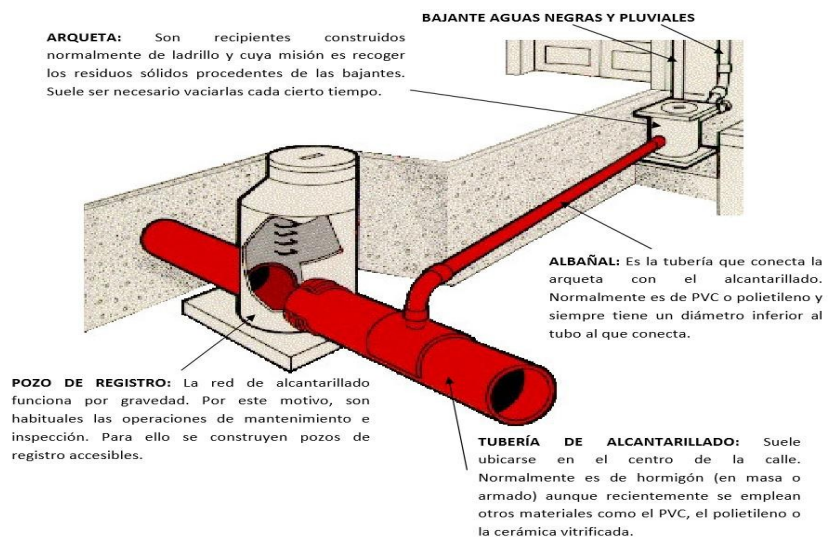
Red de desagüe y alcantarillado. (Fuente: blog BohdanKhymera)
